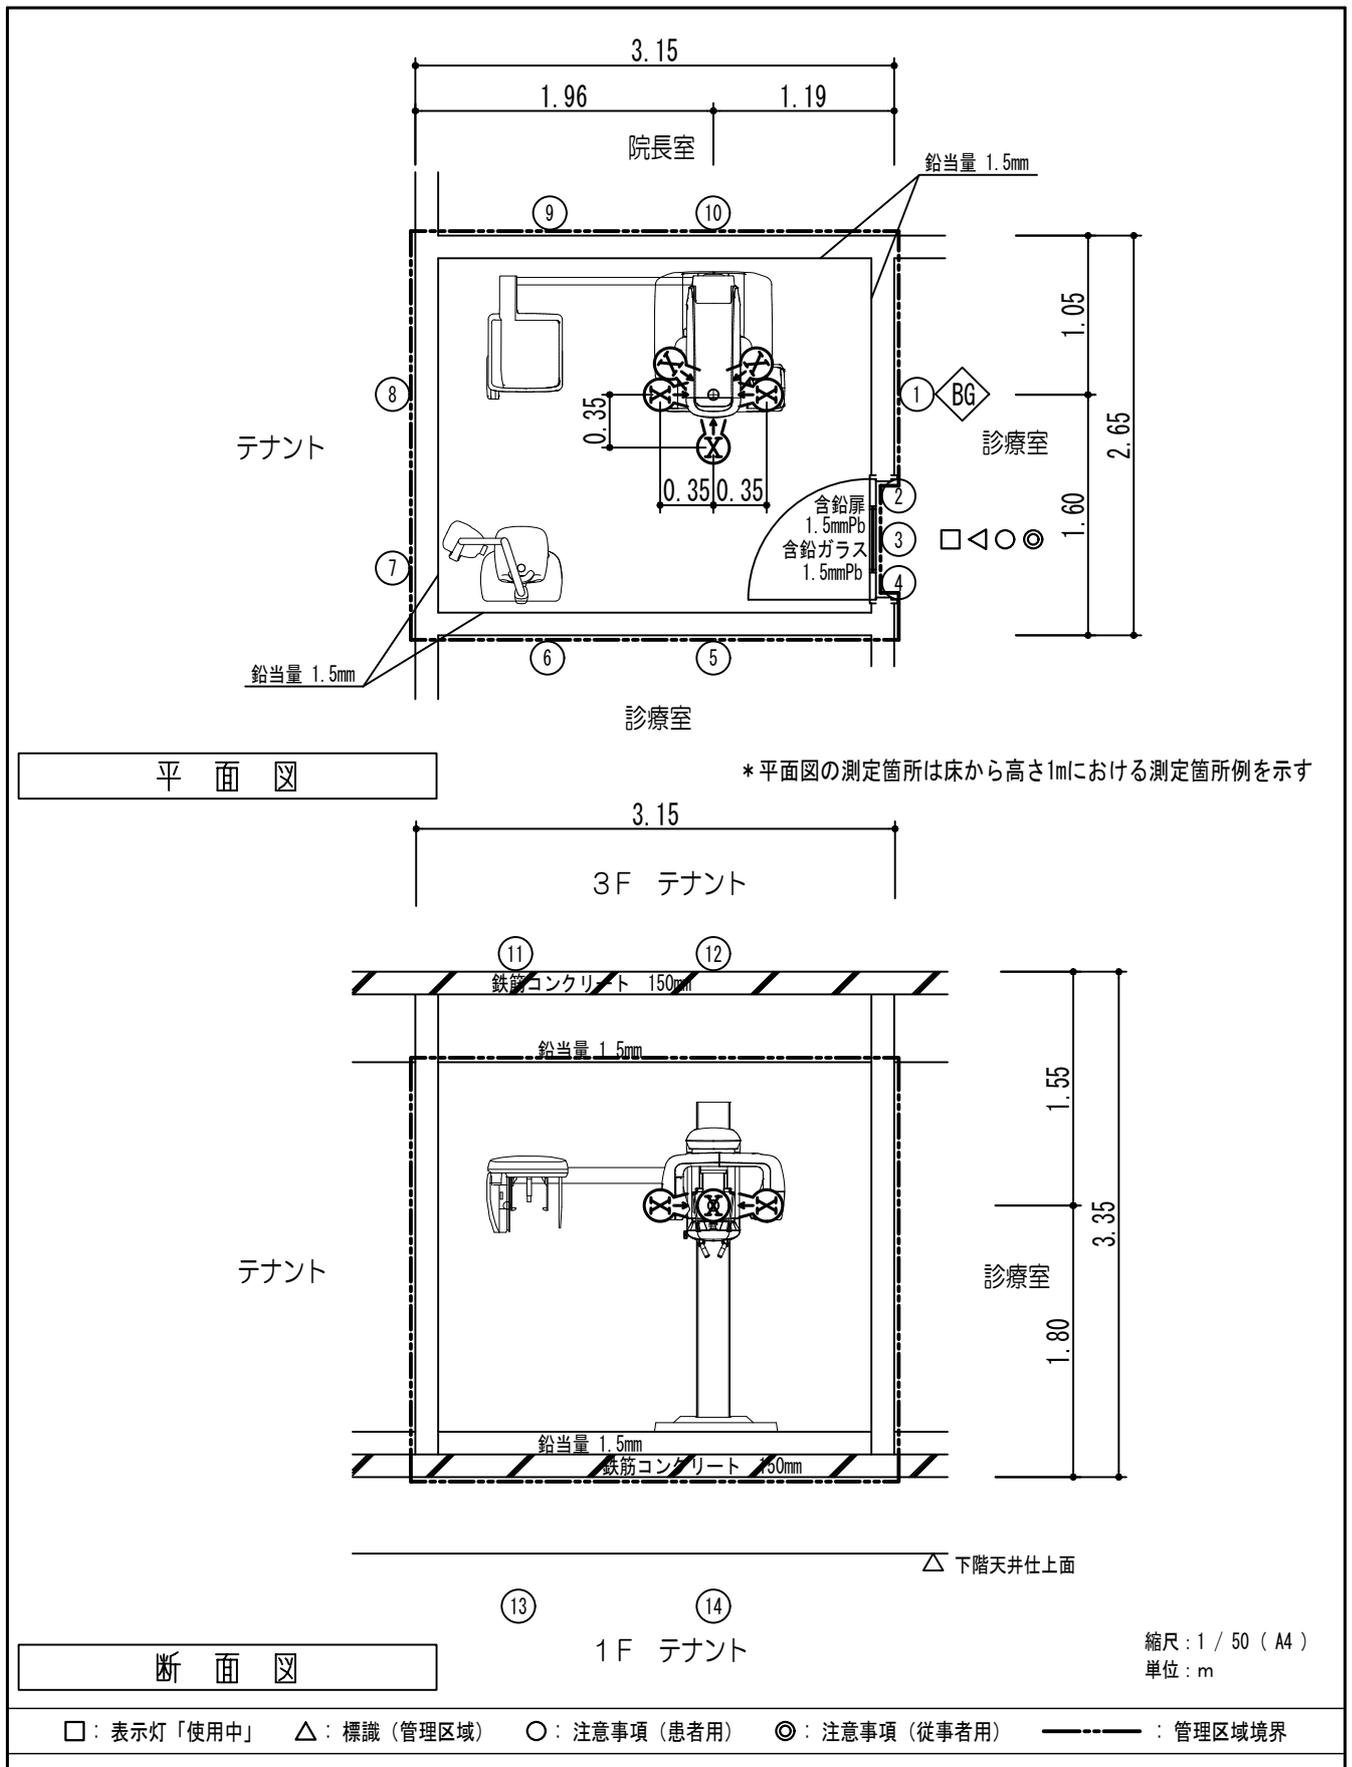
歯科用X線装置 パノラマ撮影 平面図・断面図
